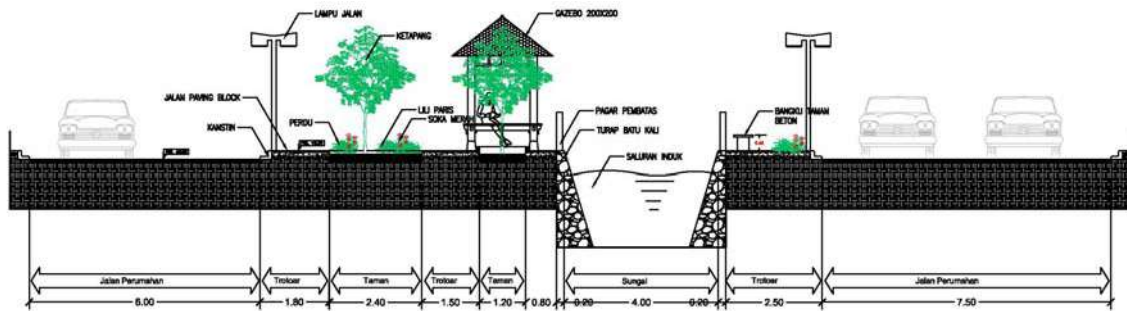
dan 16 menunjukkan gambar site plan area hijau sepanjang saluran induk. Jalur *paving block* sepanjang saluran induk dapat dimanfaatkan sebagai jalur *jogging track*. Sepanjang saluran induk juga dilengkapi bangku-bangku taman yang ditempatkan di bawah pohon agar warga bisa duduk untuk istirahat pada saat melakukan aktivitas *jogging*.
